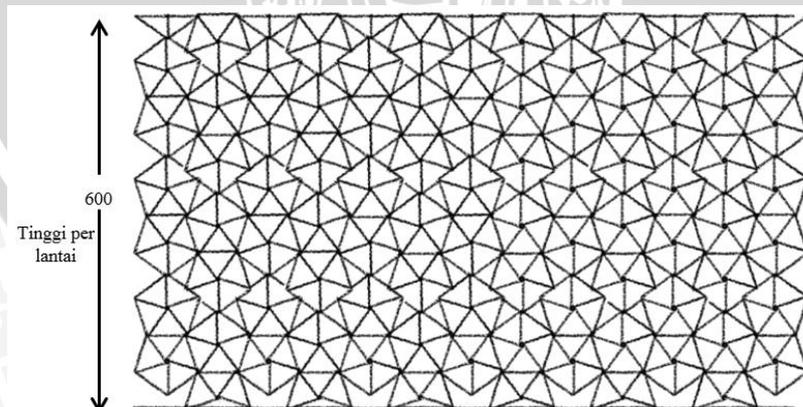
Alternatif dimensi panel 2 (50cm)
